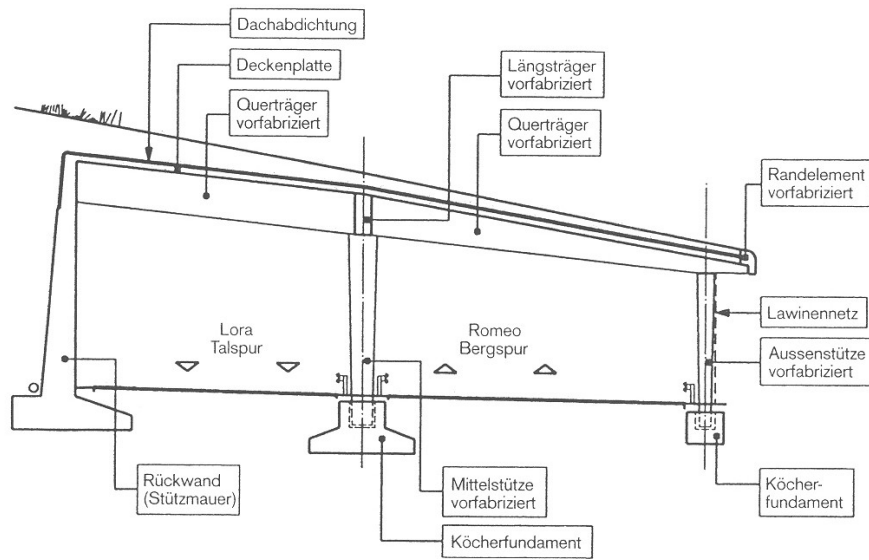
Querschnitt der Lawinengalerie Wilerplanggen.
